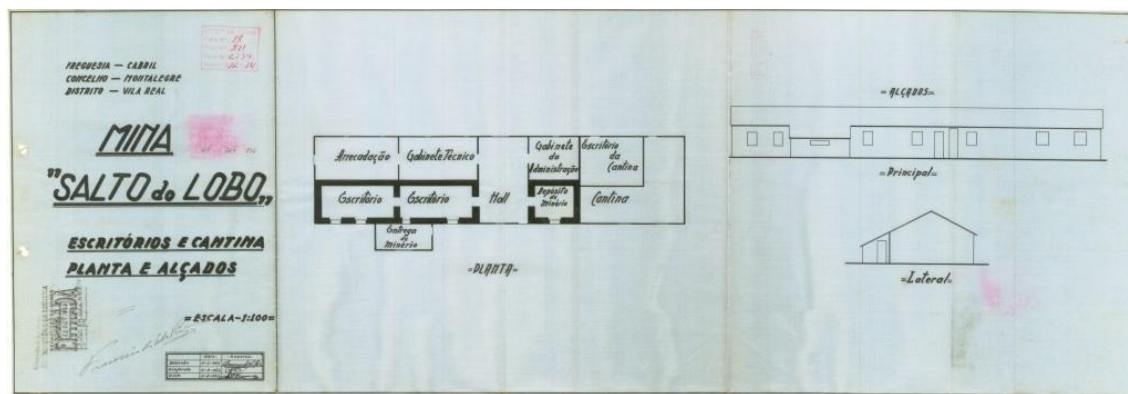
Planta relativa ao edifício Secretaria/recepção de minério/cantina (Figura 4.14 n°1) (fonte LNEG, 2013).
